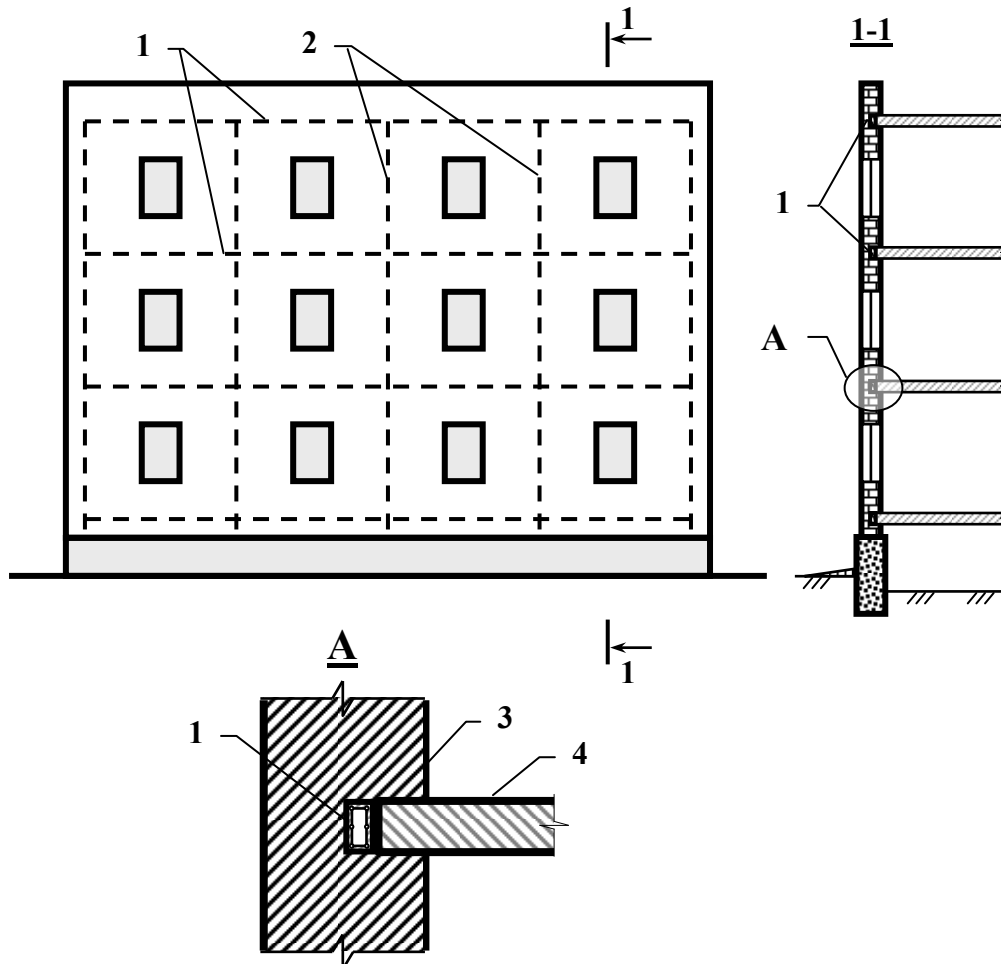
Приклад розташування антисейсмічних залізобетонних поясів і сердечників у будівлях:
